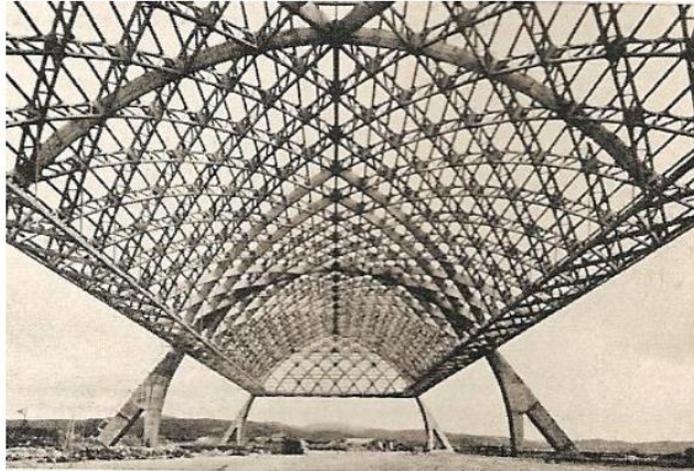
Estructura del Hangar Orvetello. Roma-Italia. Por Pier Luigi Nervi.
